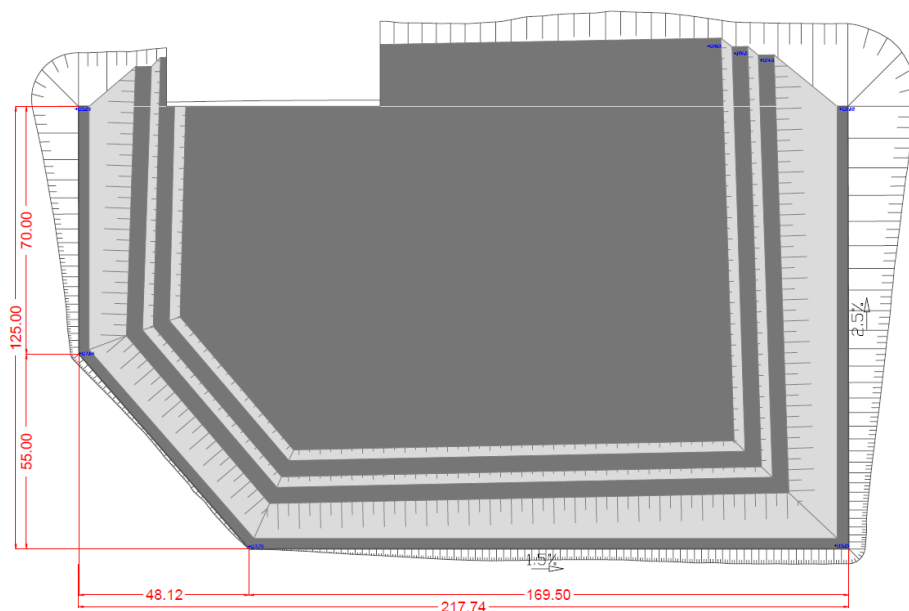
Vista de planta da Instalação Temporária de Resíduos Inertes à escala 1:750
